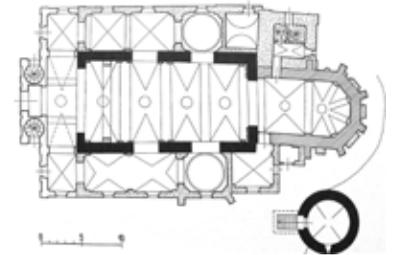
Grundriss Roučková 2006, 94. M 1:1000.
